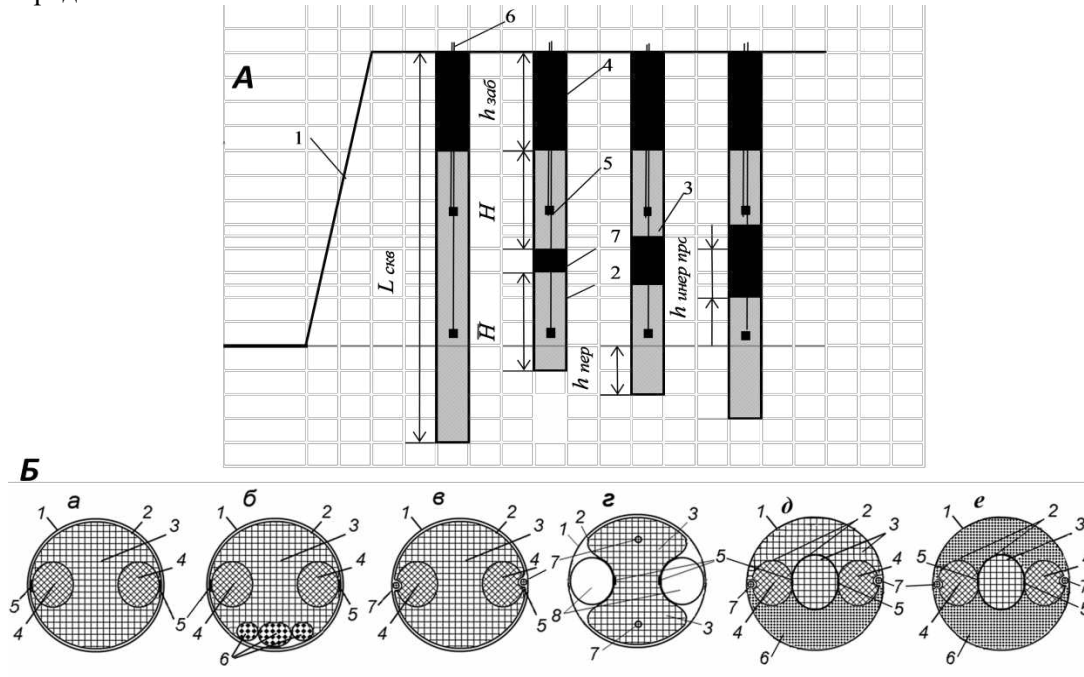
Спосіб руйнування гірських порід свердловинними зарядами з лінійно розосередженими частинами ВР. А: 1 – уступ; 2 – свердловини; 3 – заряд ВР; 4 – забивка; 5 – проміжний детонатор; 6 – хвилеводи; 7 – інертний проміжок; Б – поперечний переріз розосереджених зарядів радіально спрямованої дії: 1 – свердловина; 2 – полімерний рукав; 3 – низькобрзантний заряд; 4 – лінійні високобрзантні заряди; 5 – місця пропайки рукава; 6 – інертні демпфери; 7 – ДШ; 8 – повітряні утворювачі кумулятивних жолобів; ліворуч – натурні зразки
